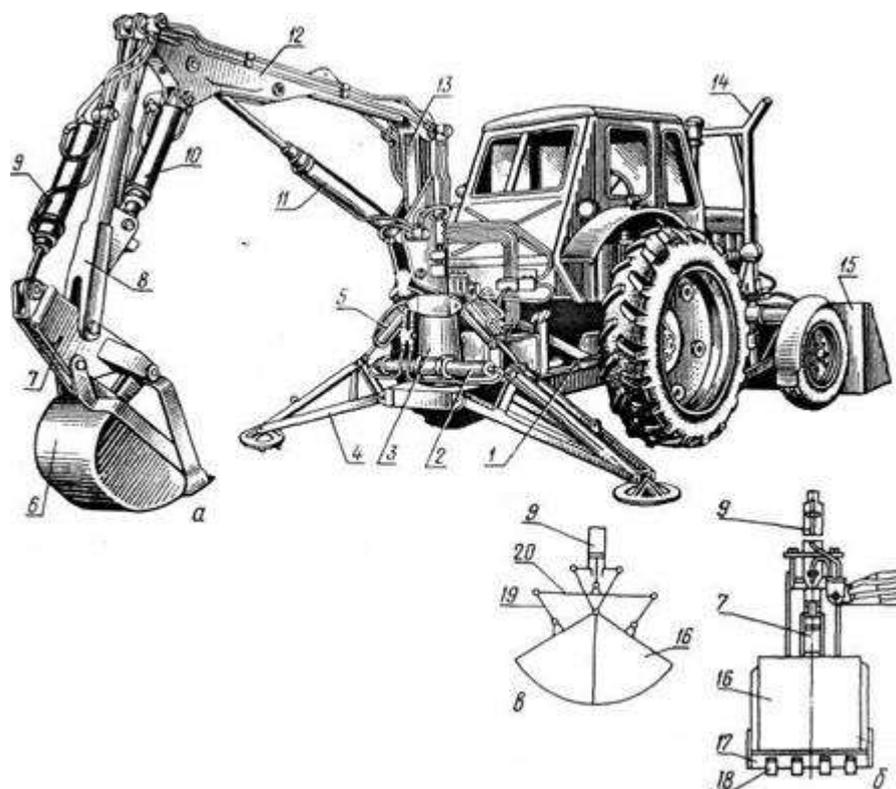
Погрузчик-экскаватор ПЭ-0,8Б: а – общий вид с лопатой; б – грейфер; в – механизм грейфера; 1 – рама; 2, 5, 9, 10 и 11 – гидроцилиндры; 3 – колонка; 4 – домкрат; 6 – лопата; 7 – рукоятка; 8 – надставка; 12 – стрела; 13 – кронштейн; 14 – подставка; 15 – бульдозер; 16 – челюсть; 17 – нож; 18 – зуб; 19 – тяга; 20 – траверса
